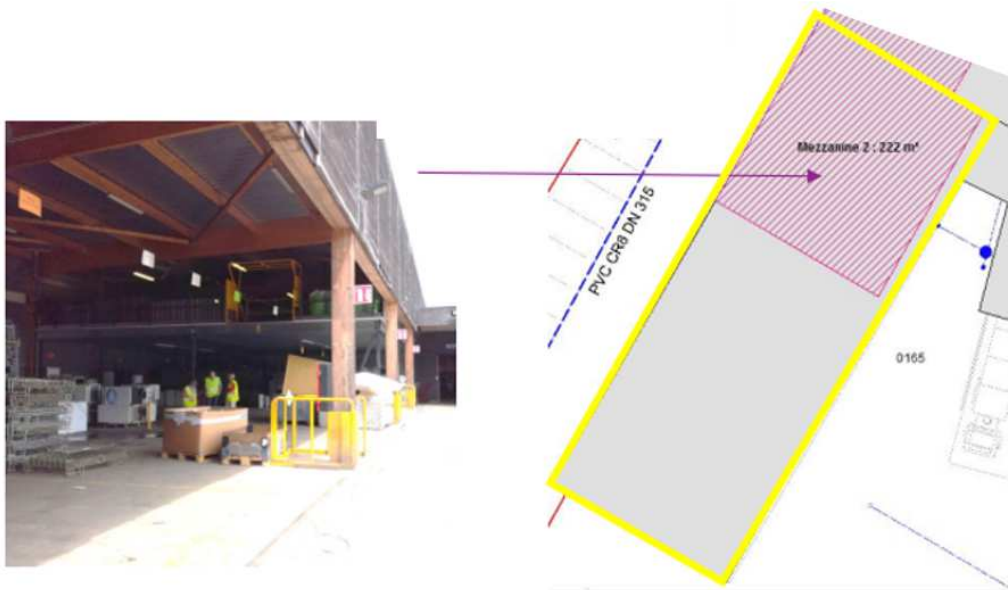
vue sur la mezzanine du bâtiment de stockage
